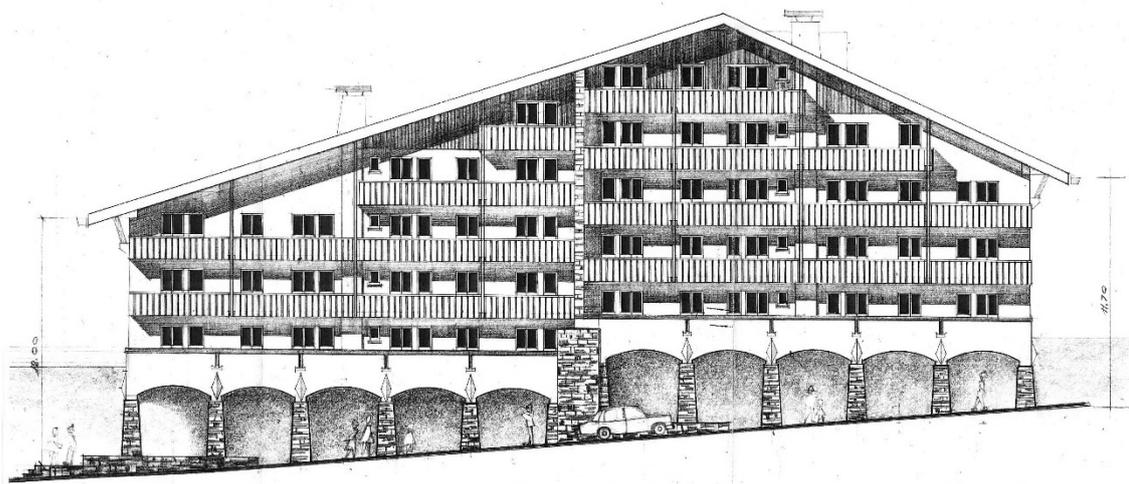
Prospetto verso via Bergamini del condominio Gran Baita Ovest – architetto Adriano Pietra
